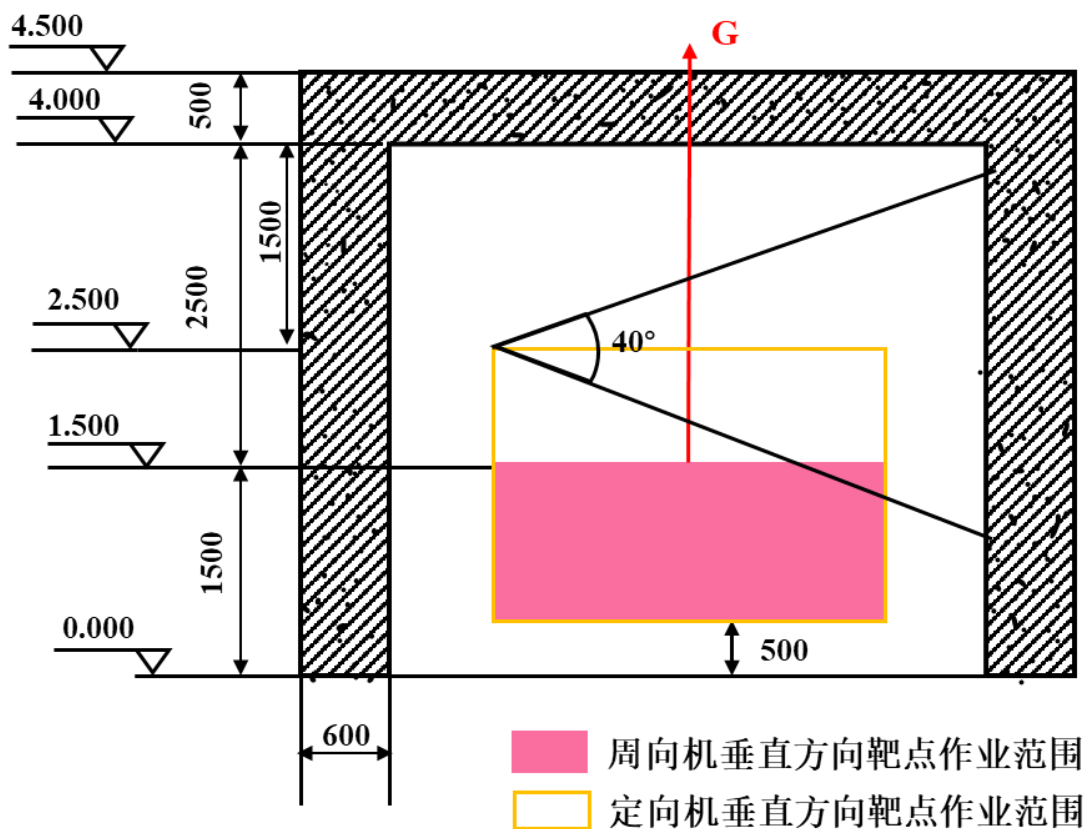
本项目探伤室预测点位剖面示意图（单位：mm）
